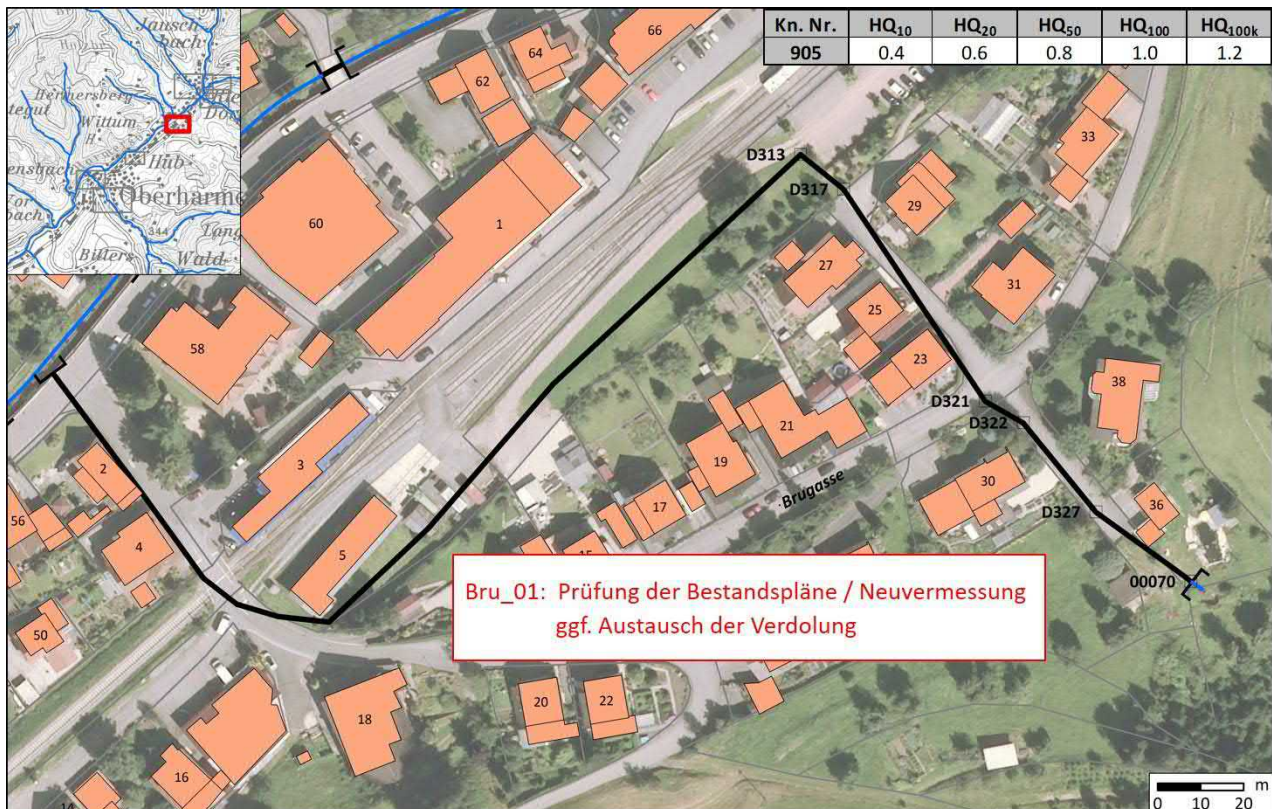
Außenbereich Brugasse – Lageplan mit vorgeschlagenen Maßnahmen
